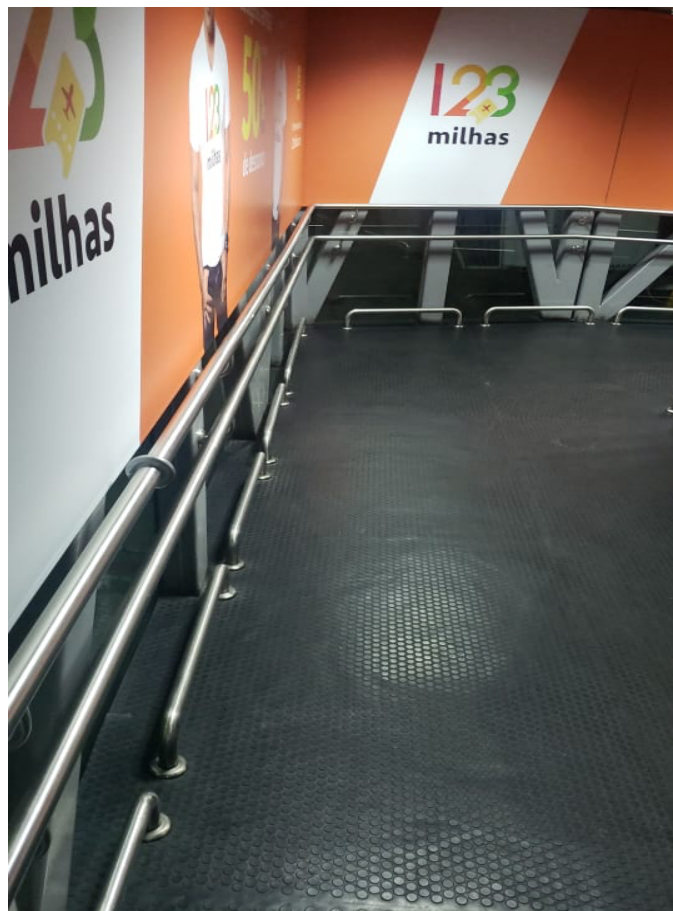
Barra de aço fixada na parede para apoio em escadas
